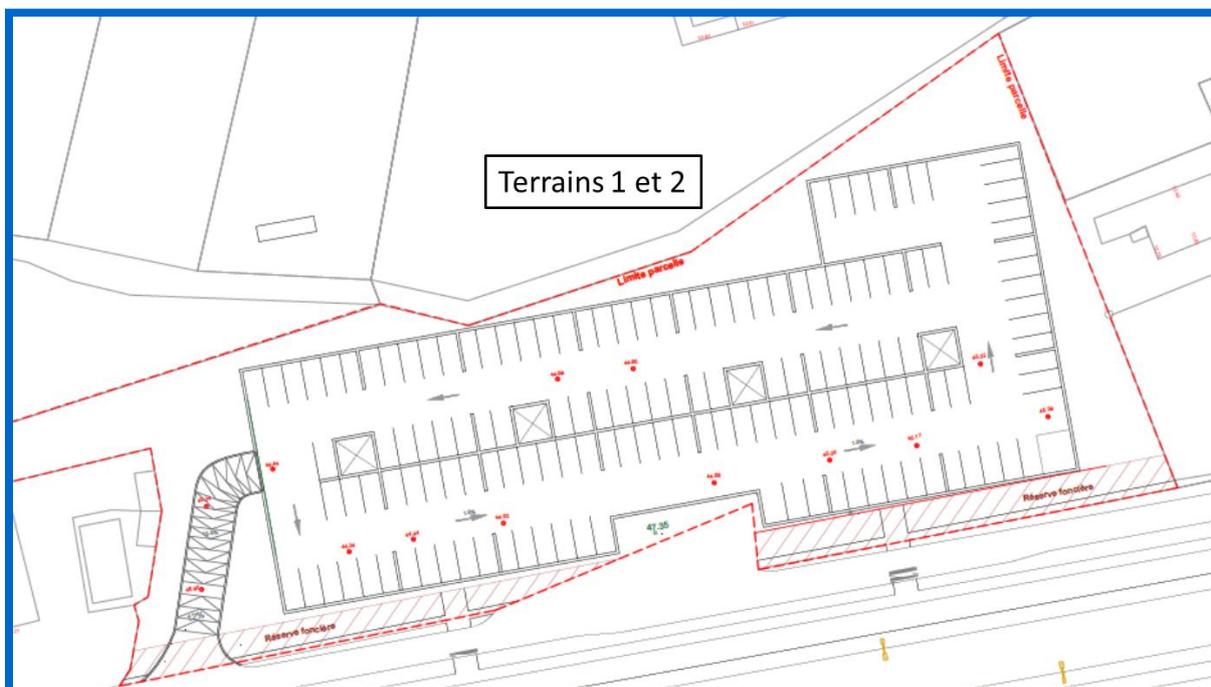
Plan futur sous-sol des terrains 1 et 2 (Cf. Annexe n°6)
